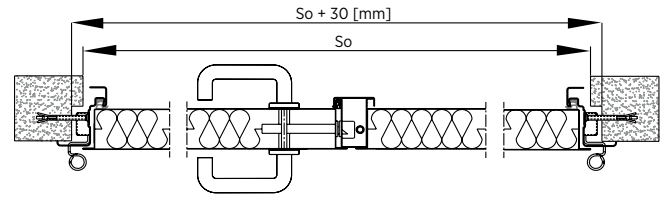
Montage mural d'un bloc-porte à deux battants avec bâti angulaire - coupe horizontale
